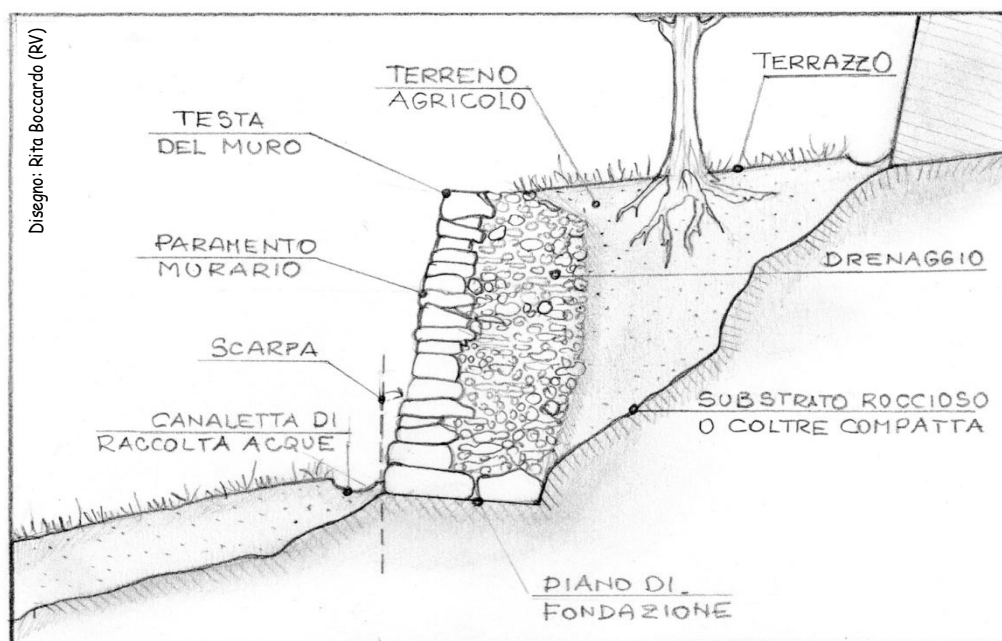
schema tipo di un terrazzamento con muretti a secco.
